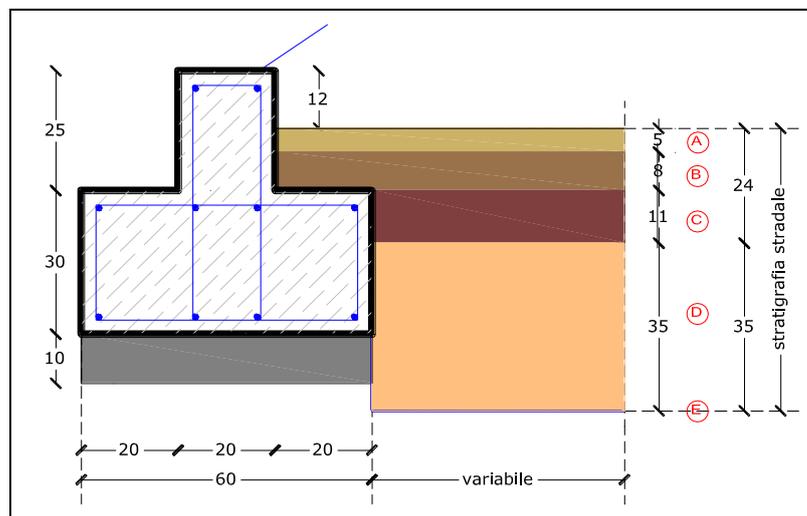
/C: particolare della struttura Fondazioni recinzioni
